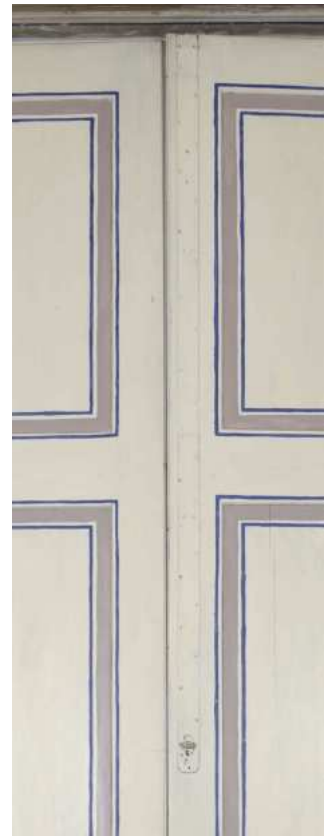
Detail obere Beschläge, Jagdspeisezimmer
